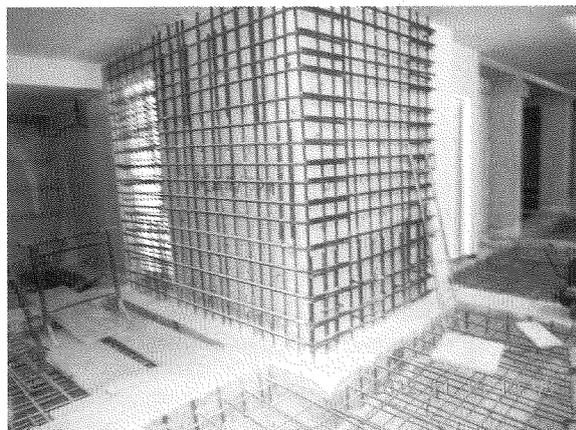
Foto G - intervento rinforzo setti ascensore e nuova platea di fondazione
